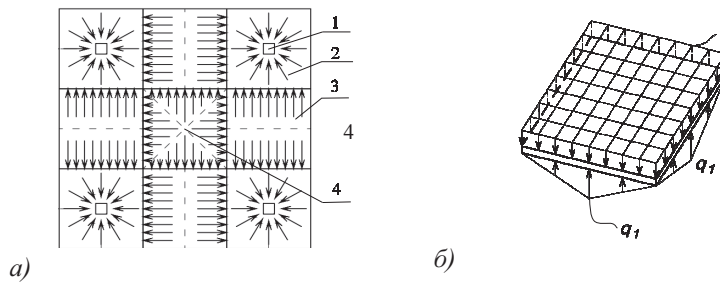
Схема розподілу навантажень: а) загальна схема передачі навантажень між елементами; б) схема завантаження середньої плити; 1) колона; 2) надколонна плита 3) міжколонна плита 4) середня плита
